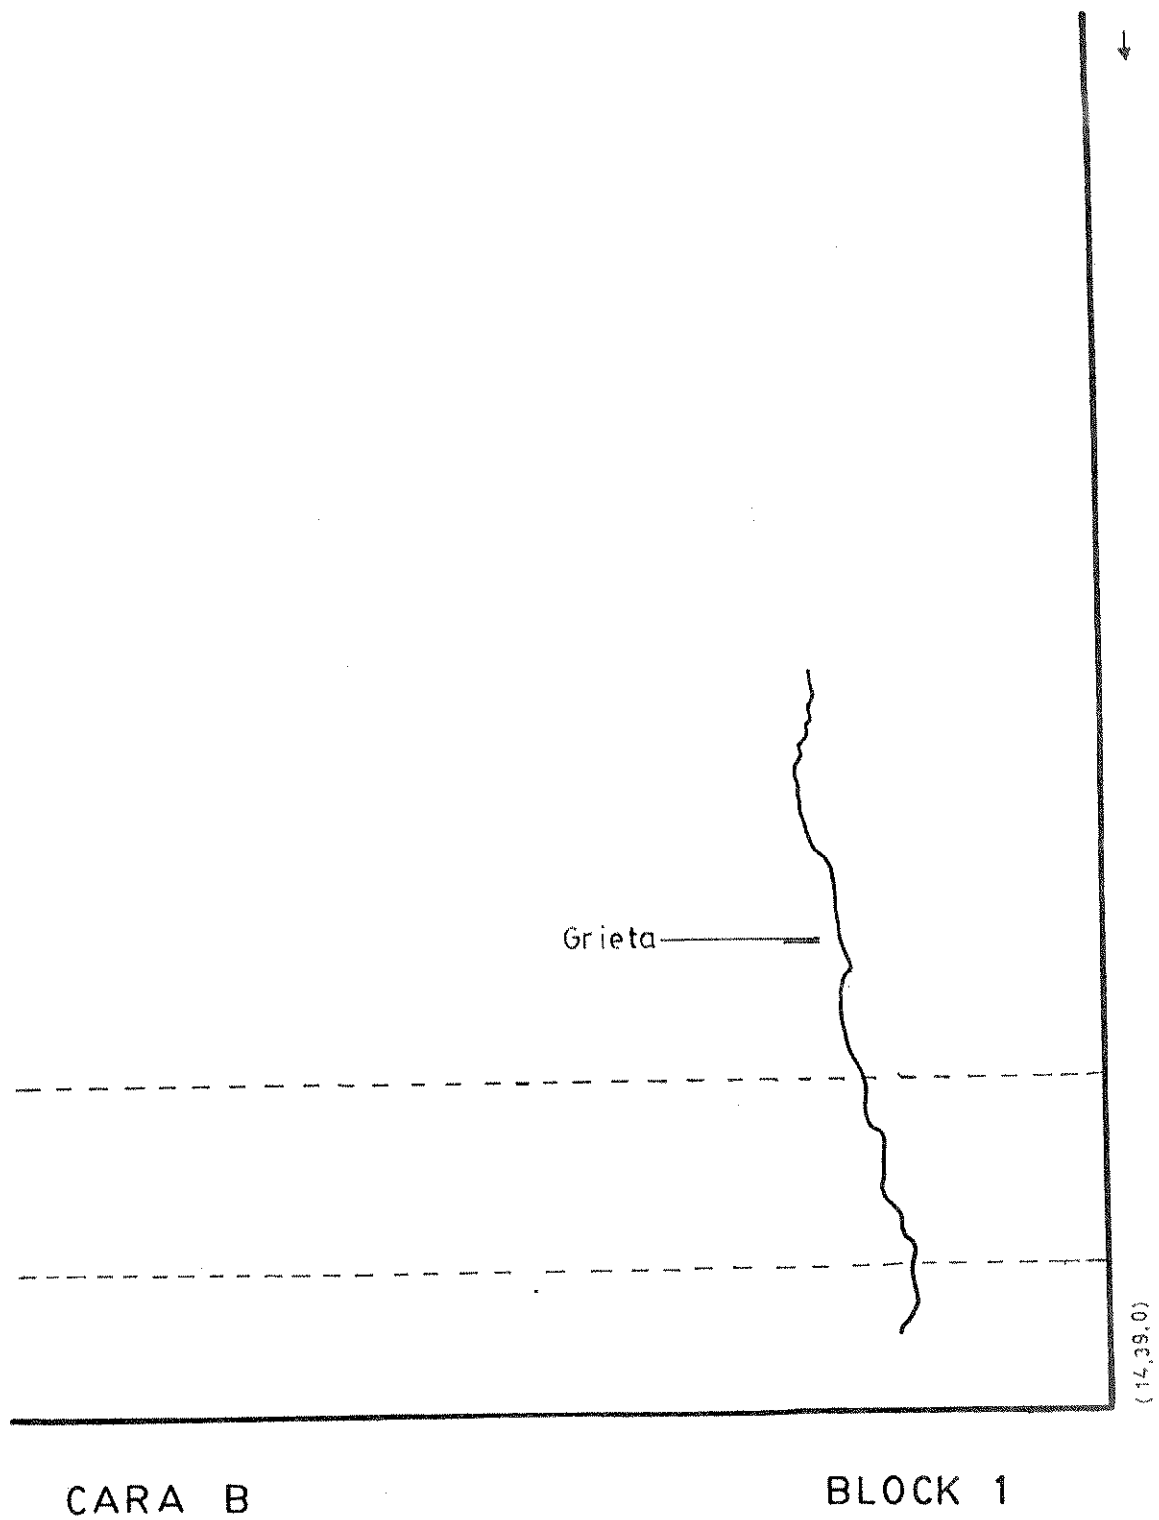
Grieta ocurrida por la carga de corte en el primer block ensayado.
